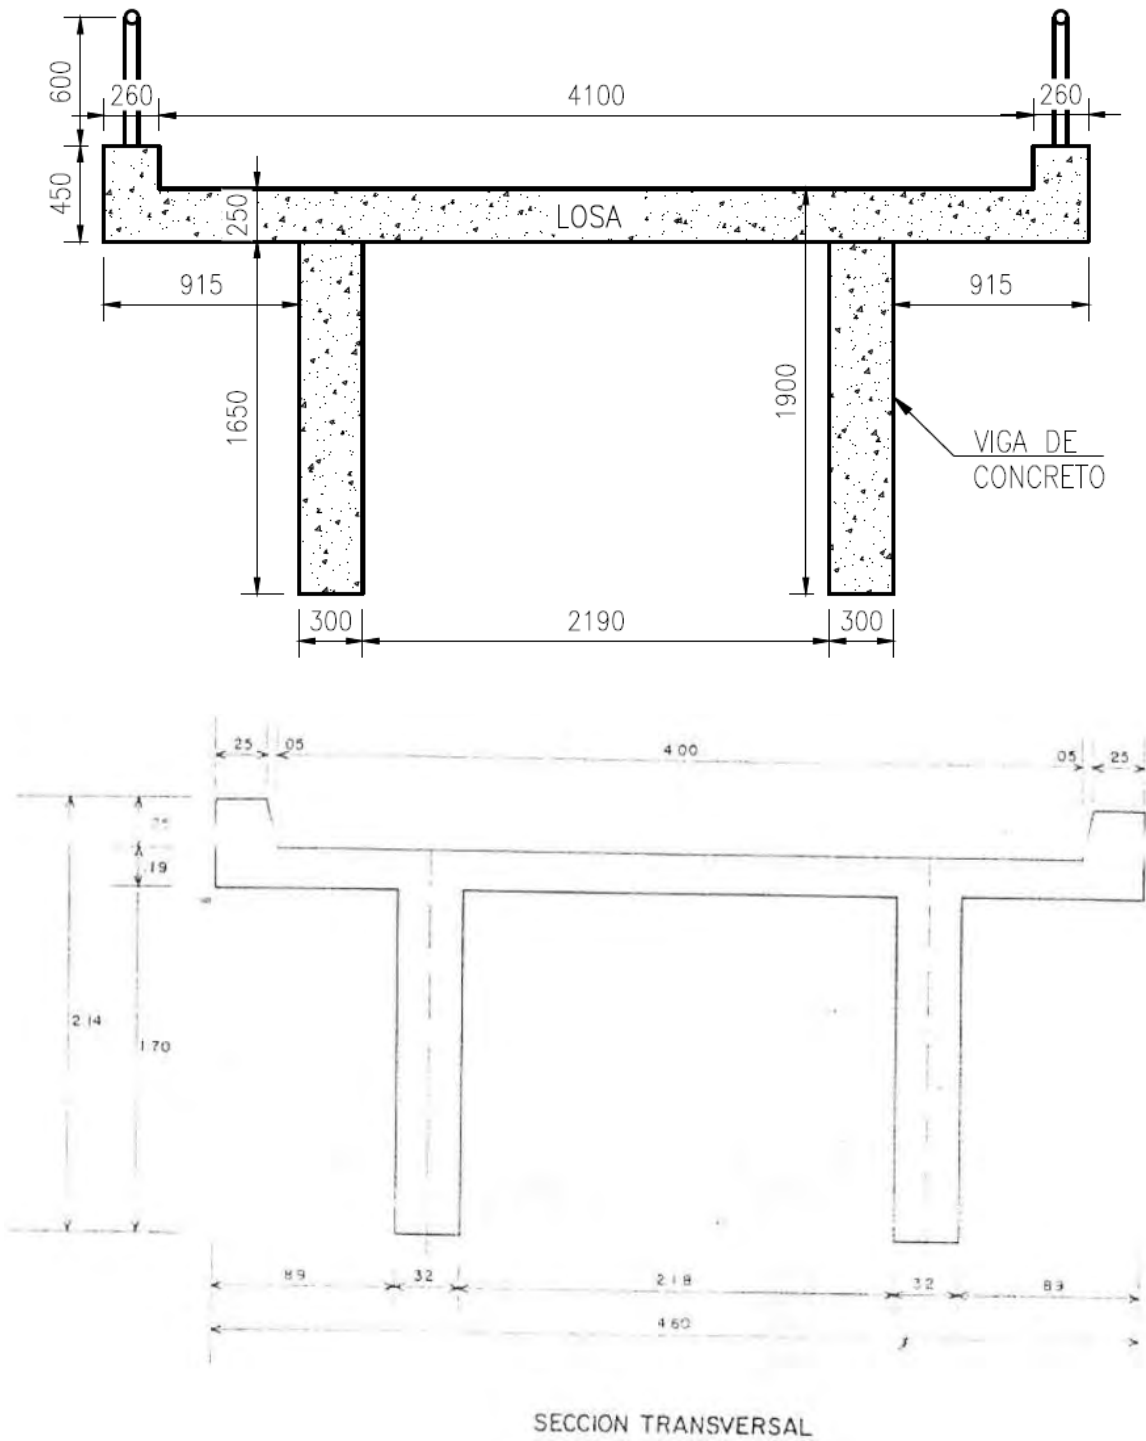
Comparación de sección transversal del puente. Arriba, puente construido. Abajo, sección adaptada de la plancha de la cartilla del Fondo Nacional de Caminos Vecinales 1976.
